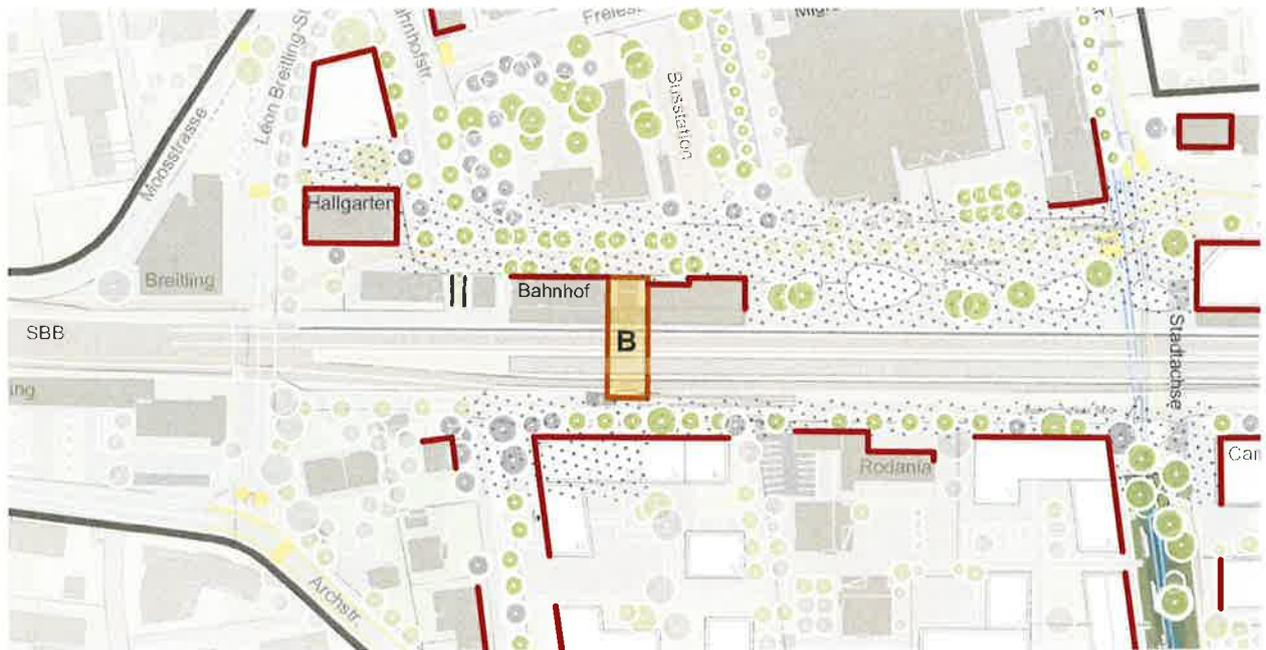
Links: Situationsplan der Stadtachse mit der im Kopfbau integrierten, gefalteten Rampe
